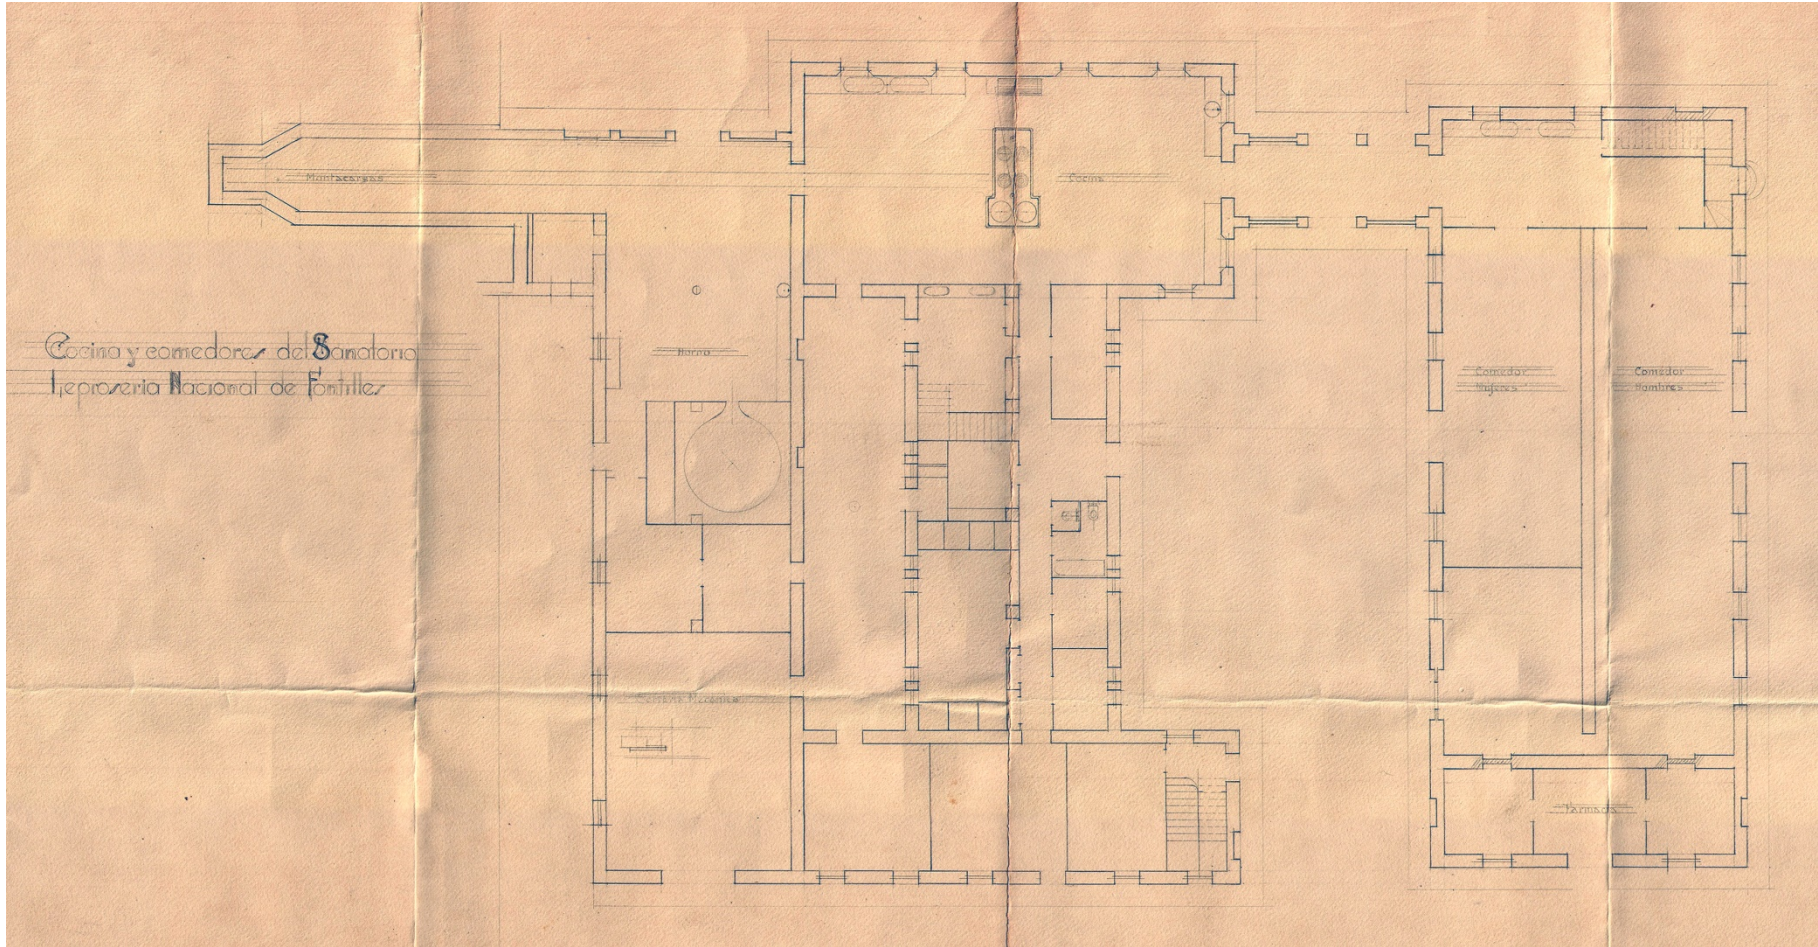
Levantamiento planimétrico del estado actual del Pabellón de Comedores y Cocina de Fontilles. Planta Baja, usos de estancias. Autoría de Juan Vidal. Año 1933 <sup>371</sup>
